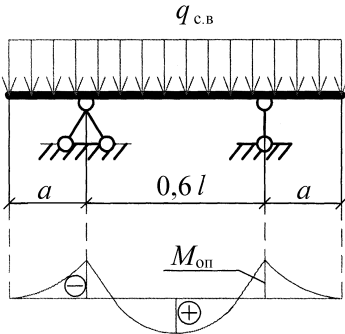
Расчетная схема плиты при подъеме и монтаже; эпюра моментов
